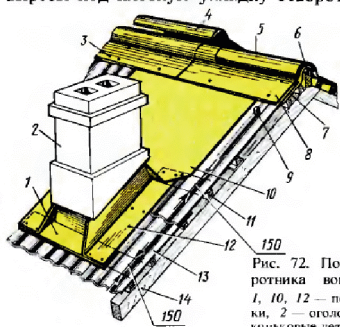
Покрытие конька и устройство воротника вокруг оголовка дымовой трубы: 1, 10, 12 — передний, затрубный и боковой уголки, 2 — оголовок дымовой трубы, 3, 4, 5, 8 — коньковые детали, 6 — коньковый брусок, 7 — прокладка из рубероида, 9 — скоба, 11 — брусок обрешетки, 13 — кровля из листов ВО, 14 — стропильная нога
